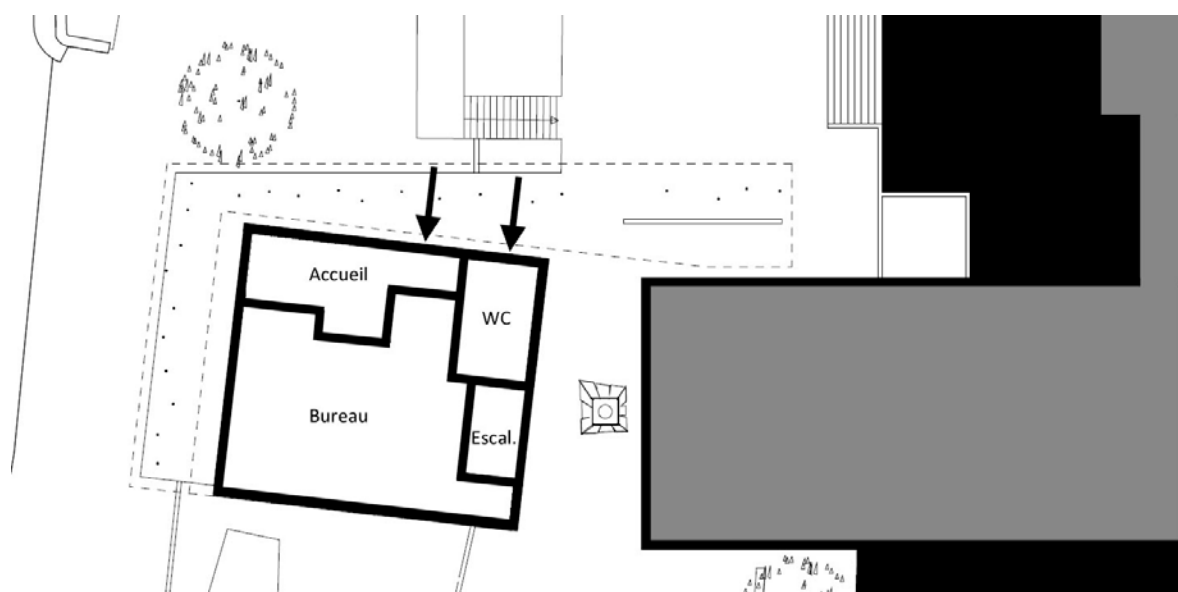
Plan du rez-de-chaussée (auteur : Bureau MSBR Nouvelle Génération)
